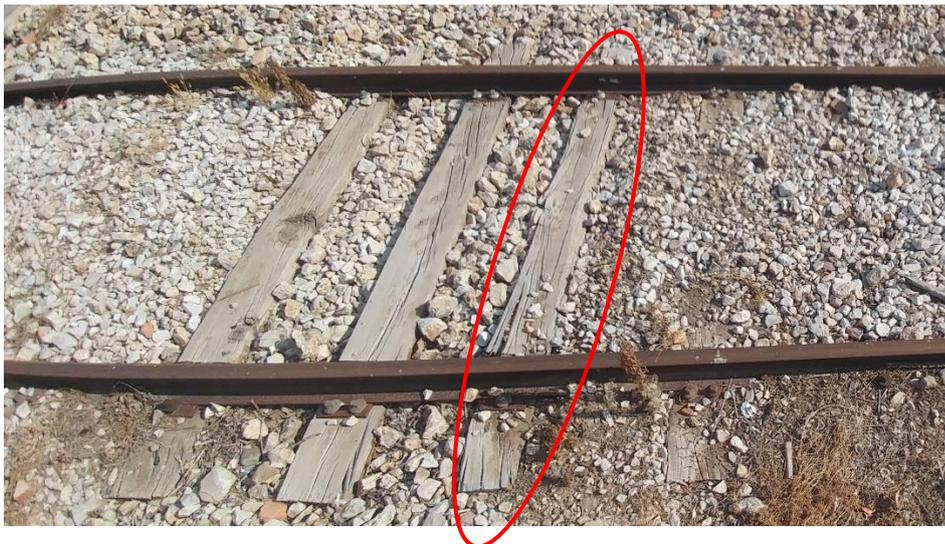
Ejemplo de traviesas fisuradas [imagen tomada en visita a vía]
